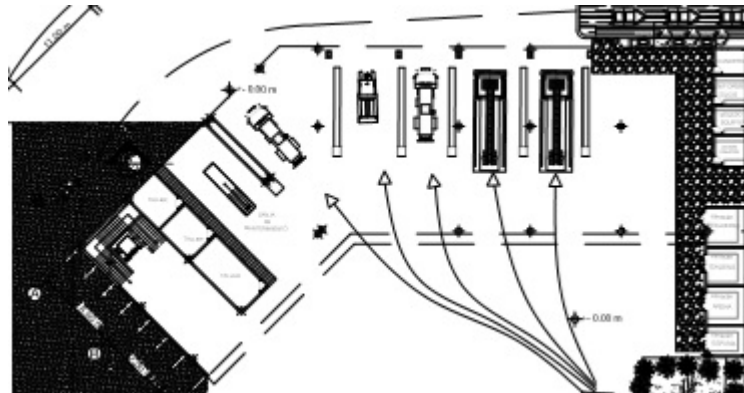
Planta baja, módulo 3, nivel +/-0.00. (2019)
